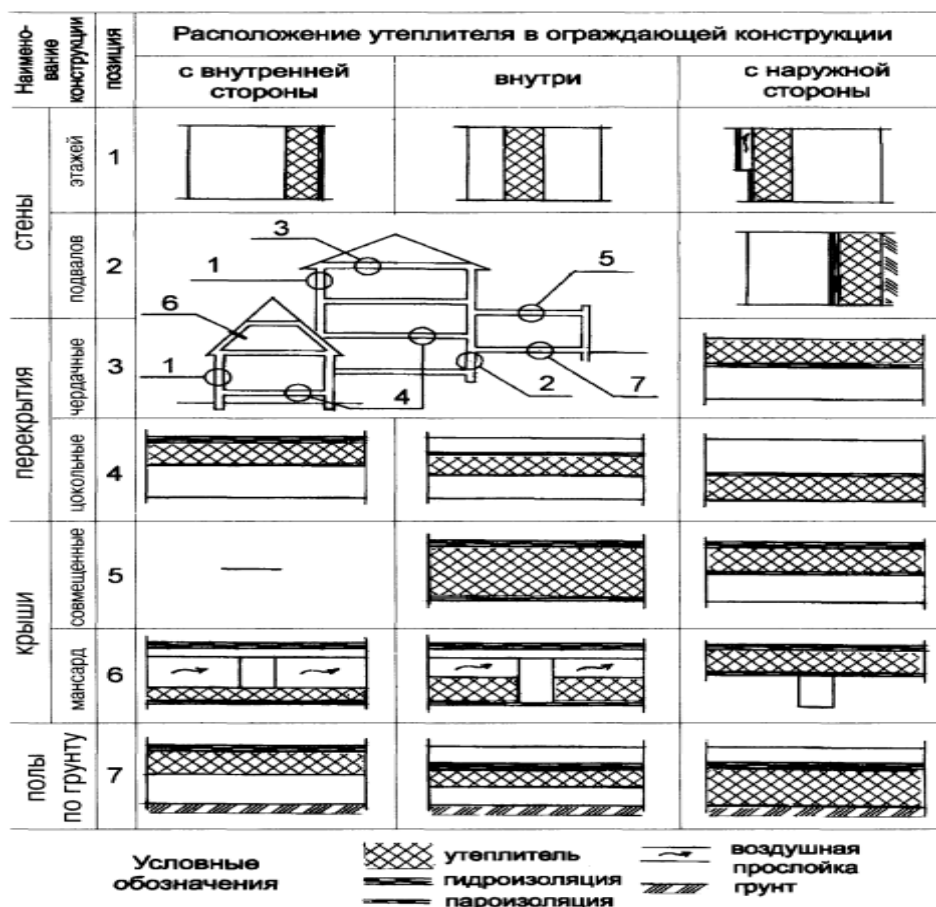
Расположение утеплителя, пароизоляции и гидроизоляции в наружных ограждениях.
